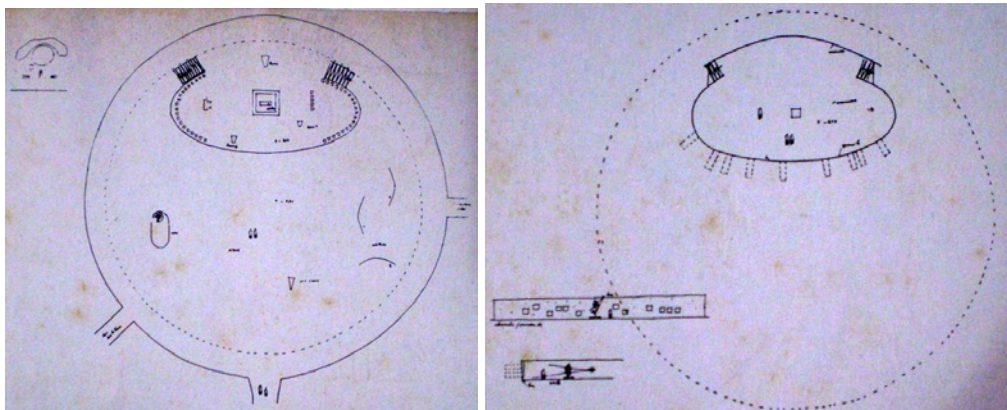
Croqui Planta da Nave da Catedral / Planta Cripta da Catedral.
